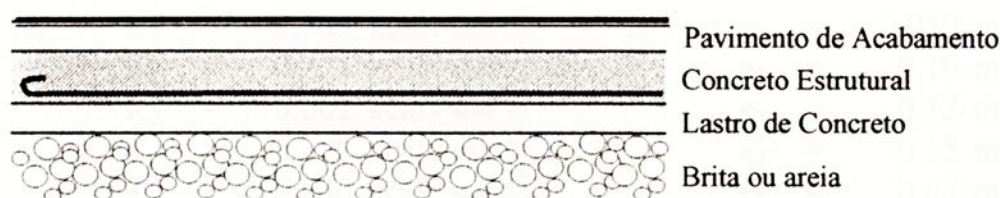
Corte do piso do pavimento térreo do edifício, considerando alvenaria com tijolos maciços, blocos de concreto ou blocos cerâmicos
